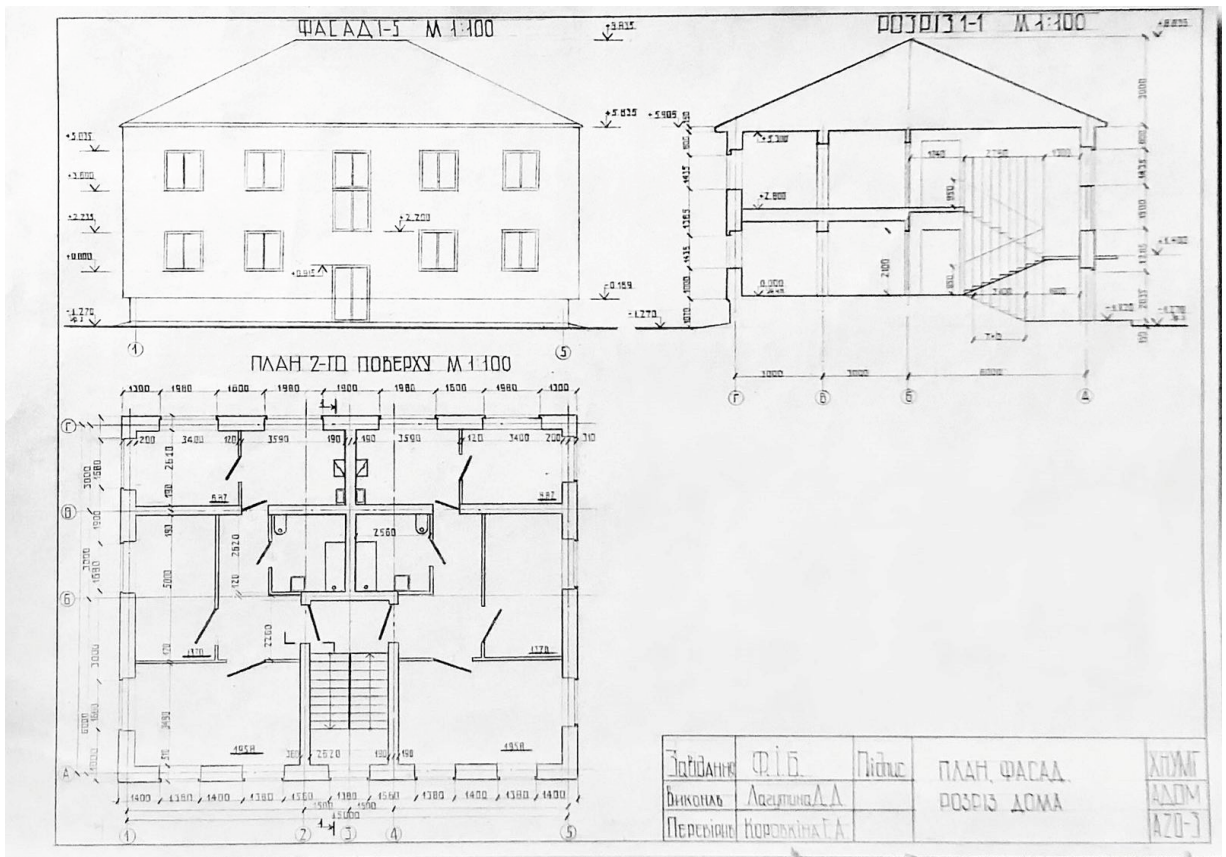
Архітектурне креслення «План, фасад та розріз будівлі».
